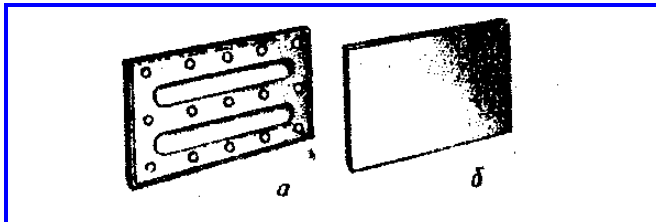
Малогабаритні фасадні плитки: а – тильна поверхня ; б – лицьова поверхня
